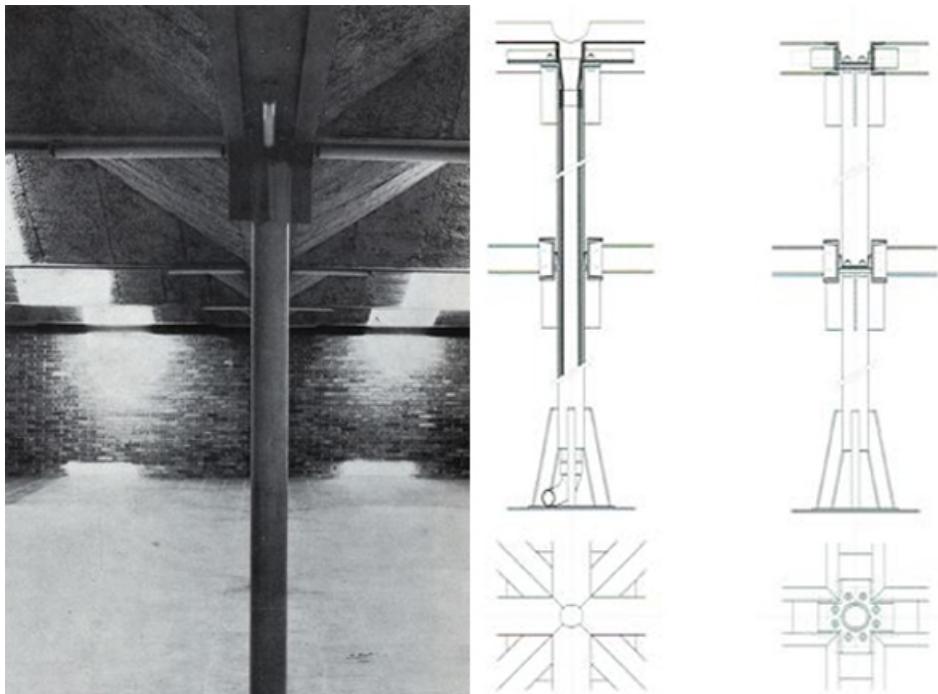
Detalles constructivos del módulo de cubierta y el sistema de drenaje de la Iglesia de Almendrales
